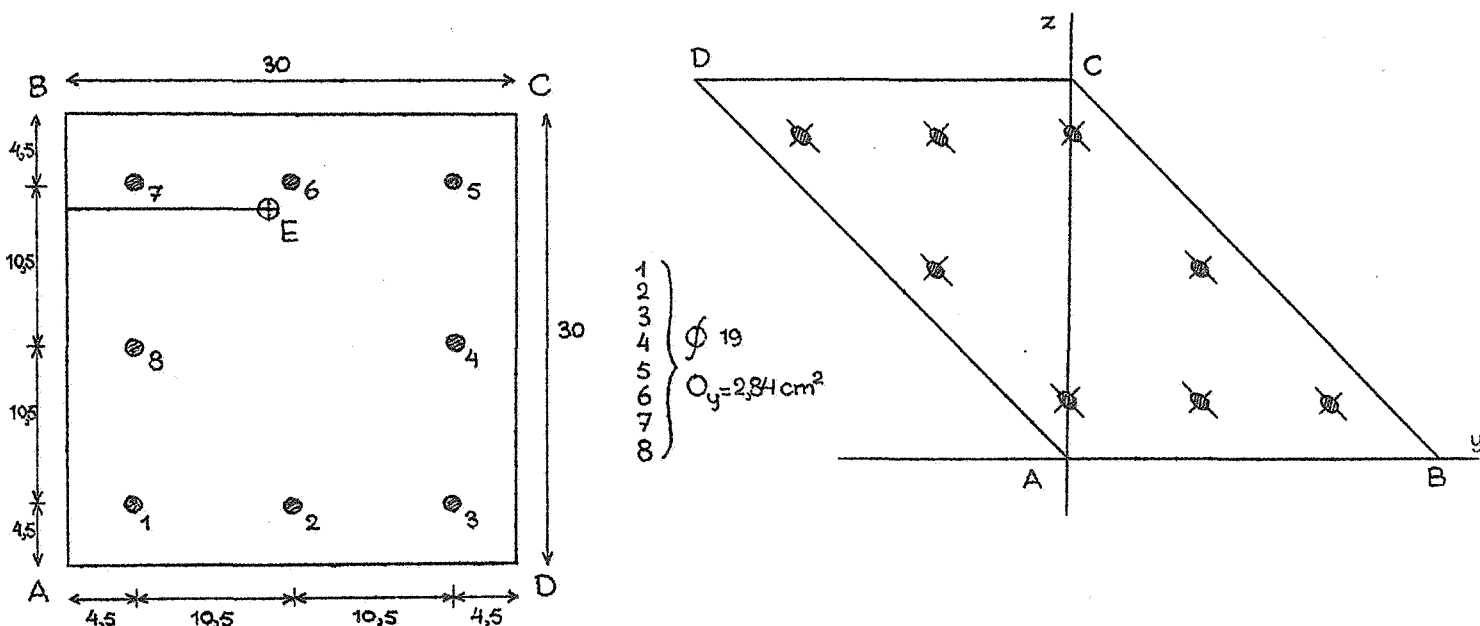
Betondoorsnede, metrisch en barycentrisch.
